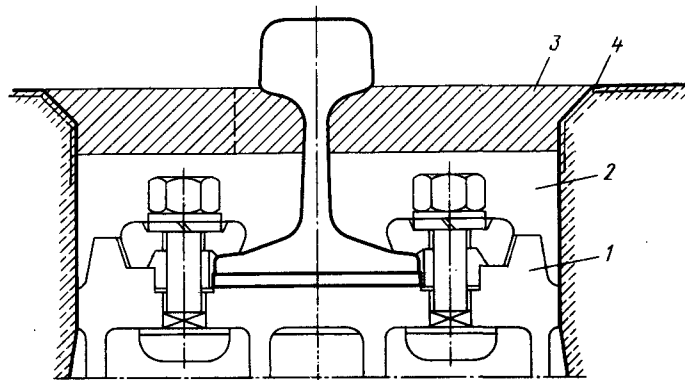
Схема установки кранового пути козлового крана с размещением рельса на одном уровне с головкой покрытия площадки
